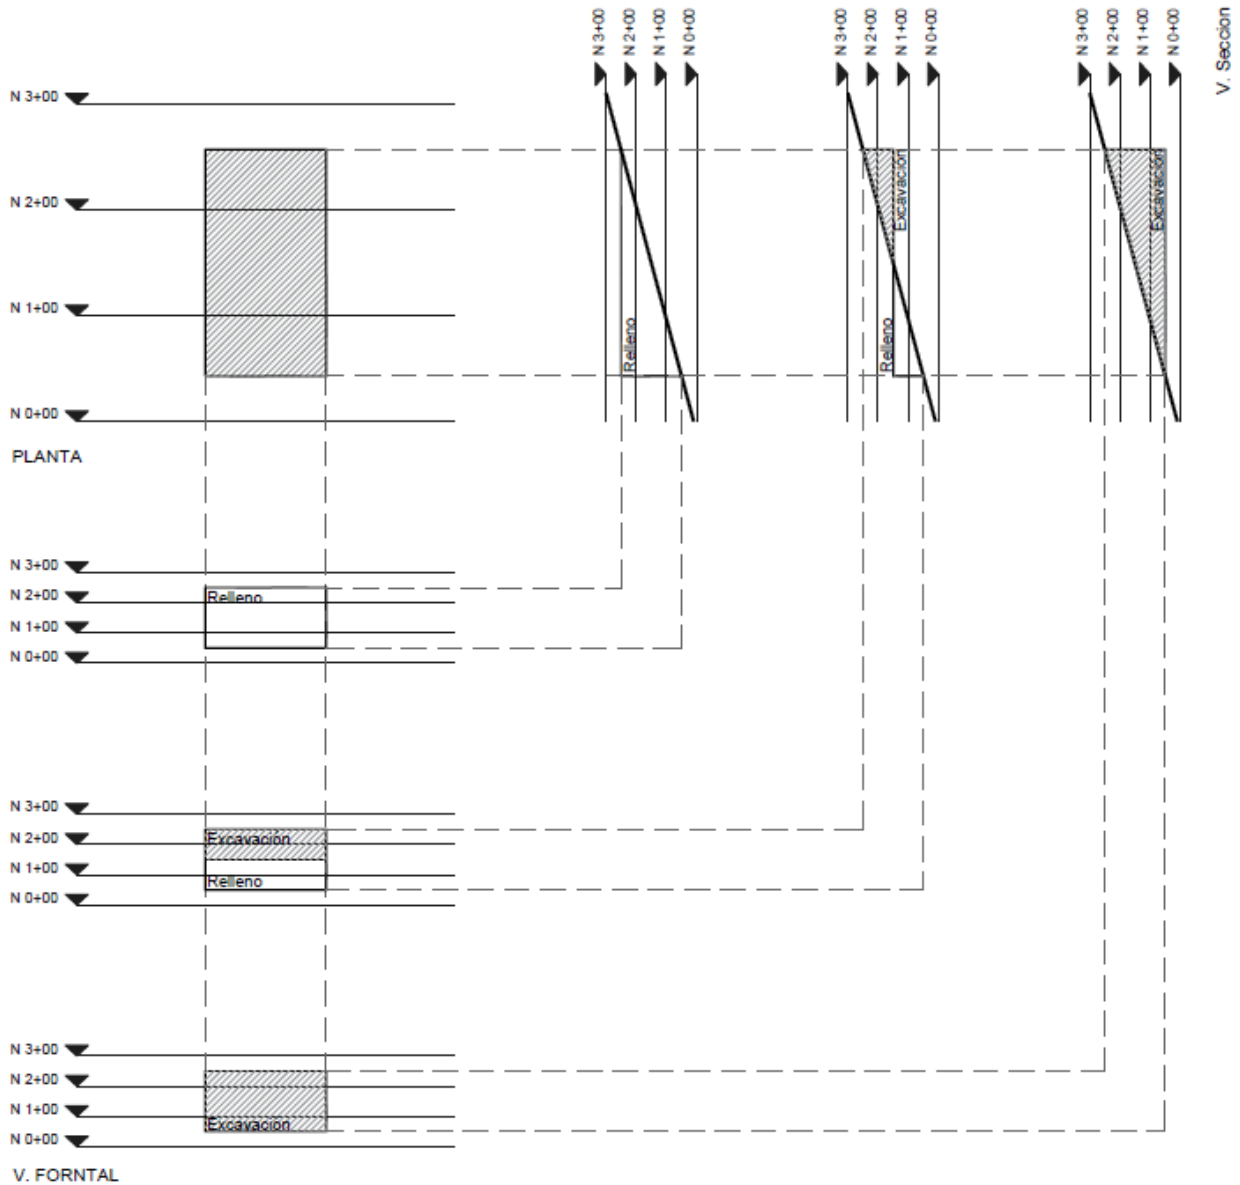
Desplante de cimentaciones en un plano inclinado.
